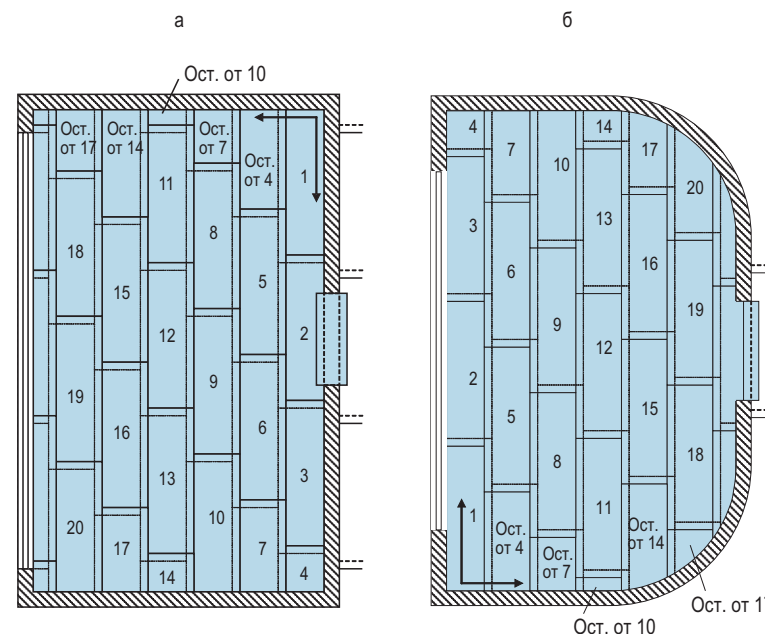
Схемы раскладки элементов пола при укладке от стены с дверным проемом (а) и при укладке от стены, противоположной дверному проему (б)
